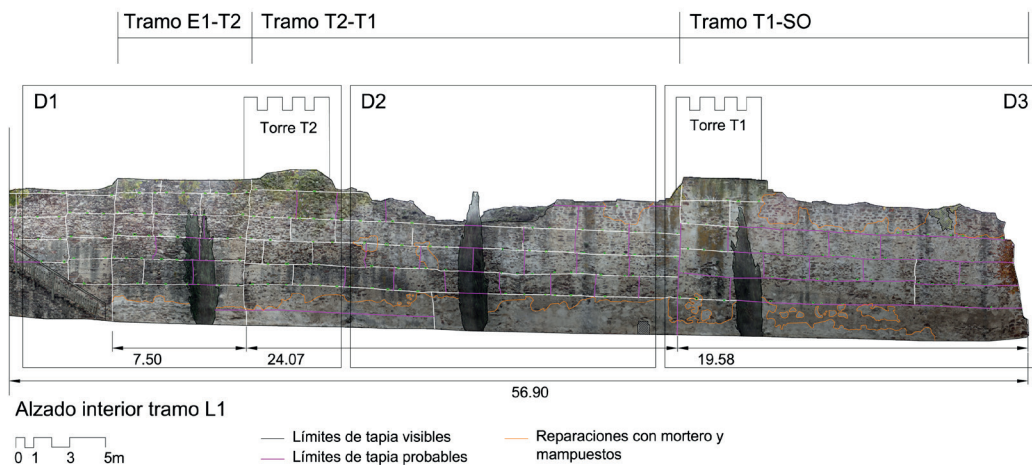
Alzado interior de la muralla de Coca, Segovia. Fuente: Elaboración propia.
